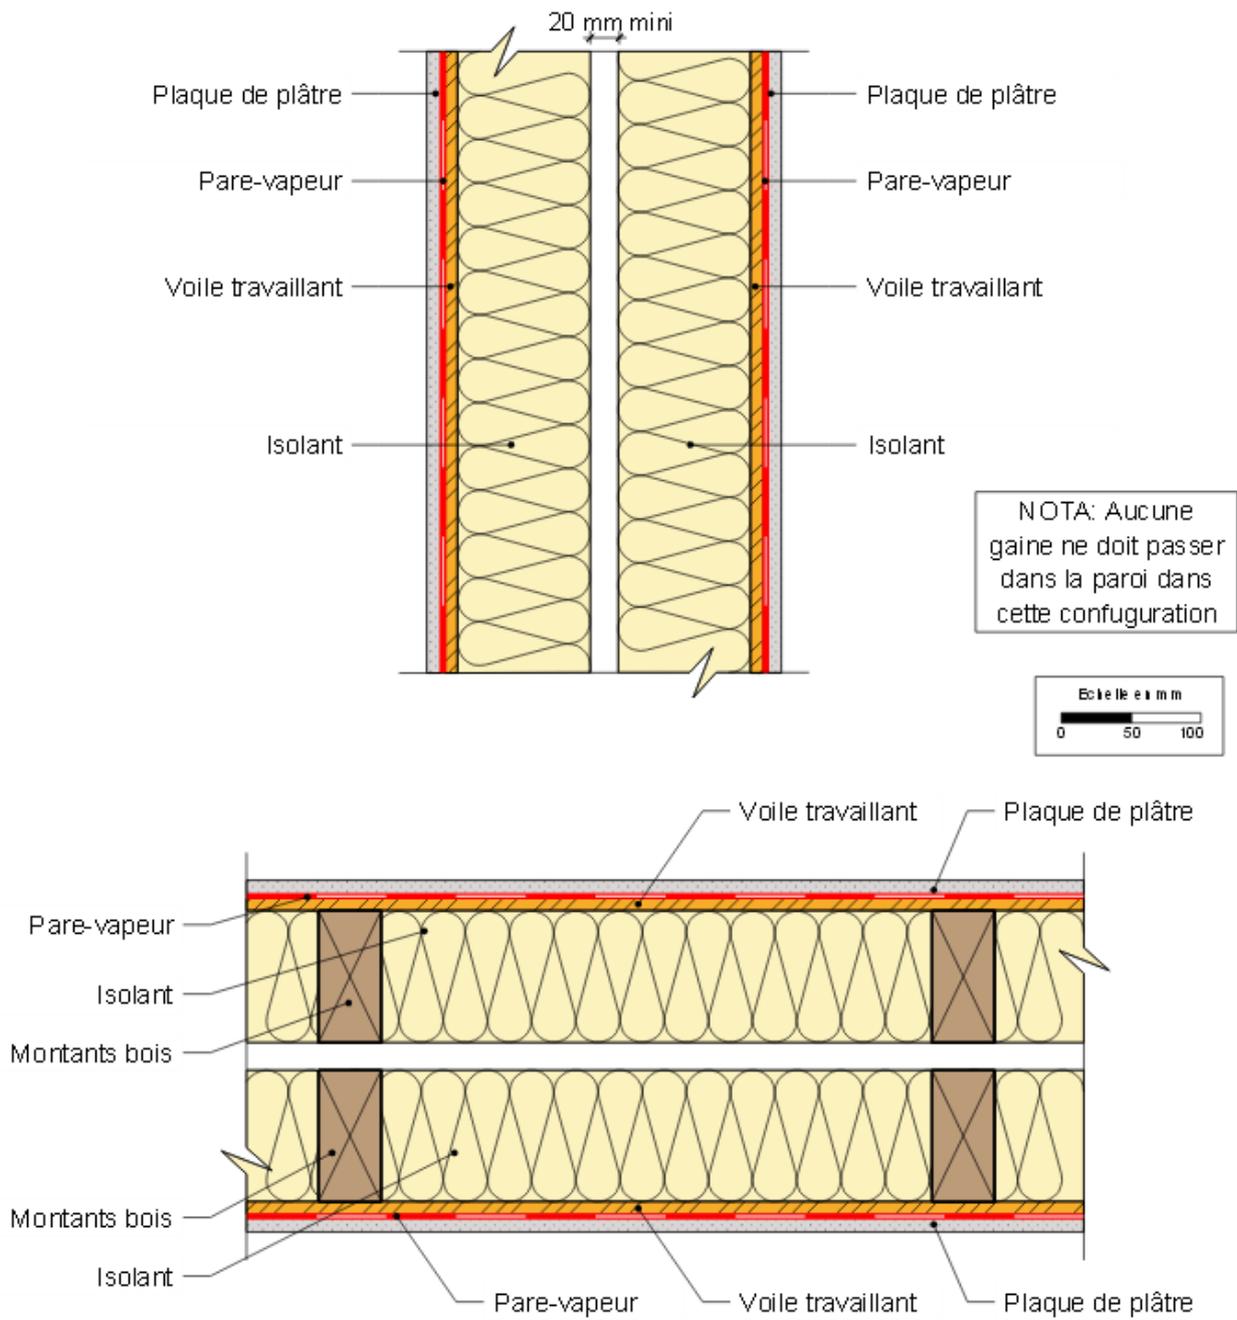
Contreventement côté intérieur et pose directe du parement (coupe verticale en haut, verticale en bas)
